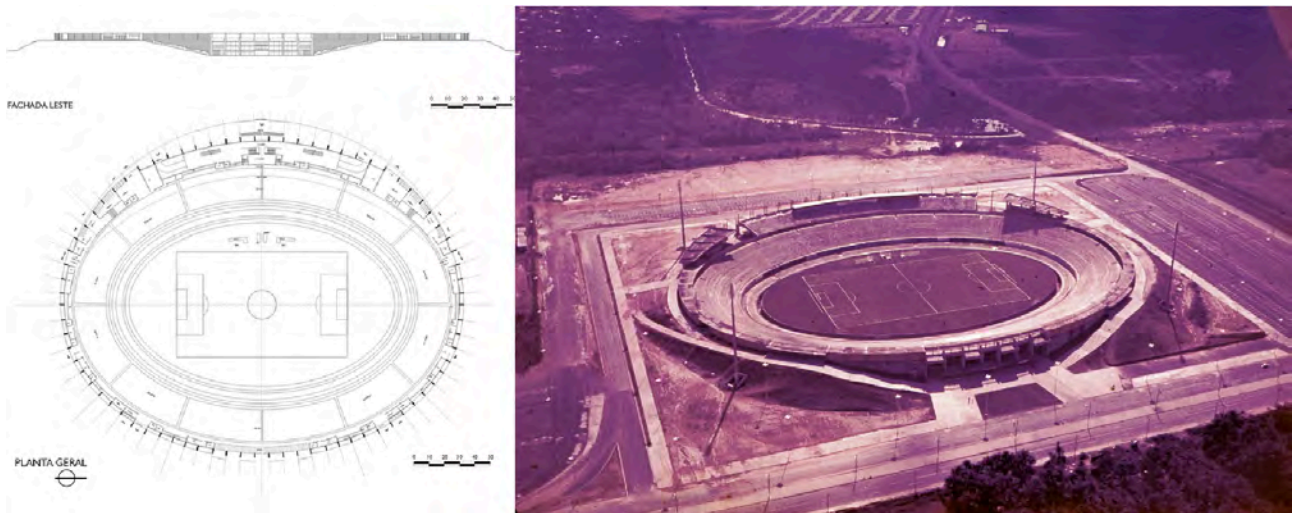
e 29 - Estádio Vivaldo Lima | Planta e fachada leste | Severiano Porto, [entre 1971-1975]
